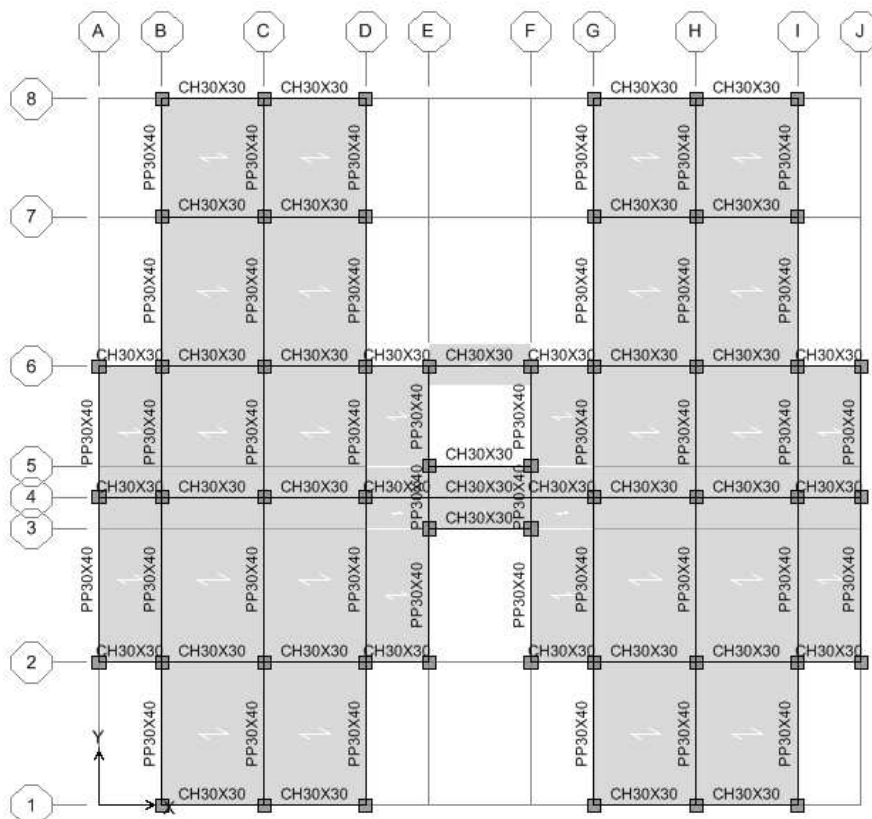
image vue en plan de la structure (portique) sur ETABS
